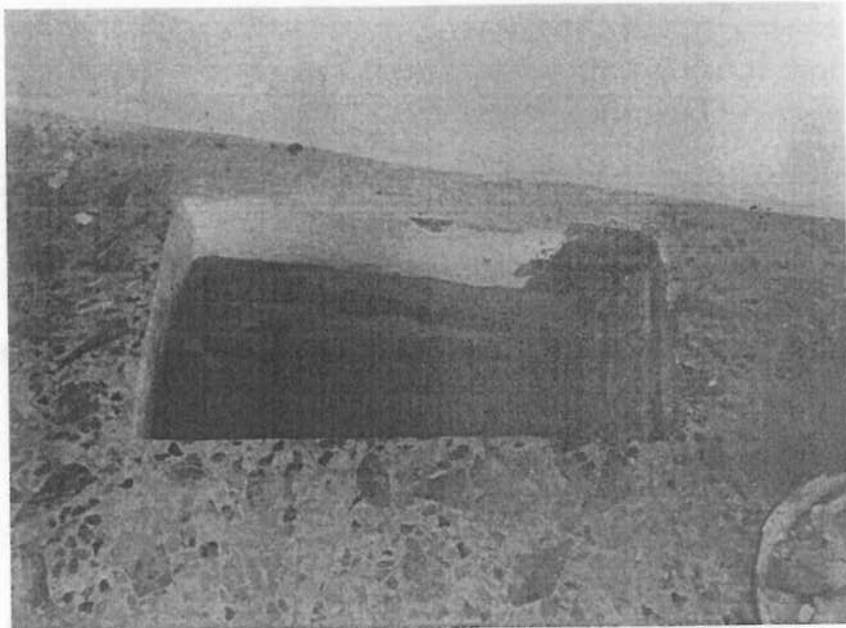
Foro praticato nel solaio per collegare il piano terra con il primo piano.
